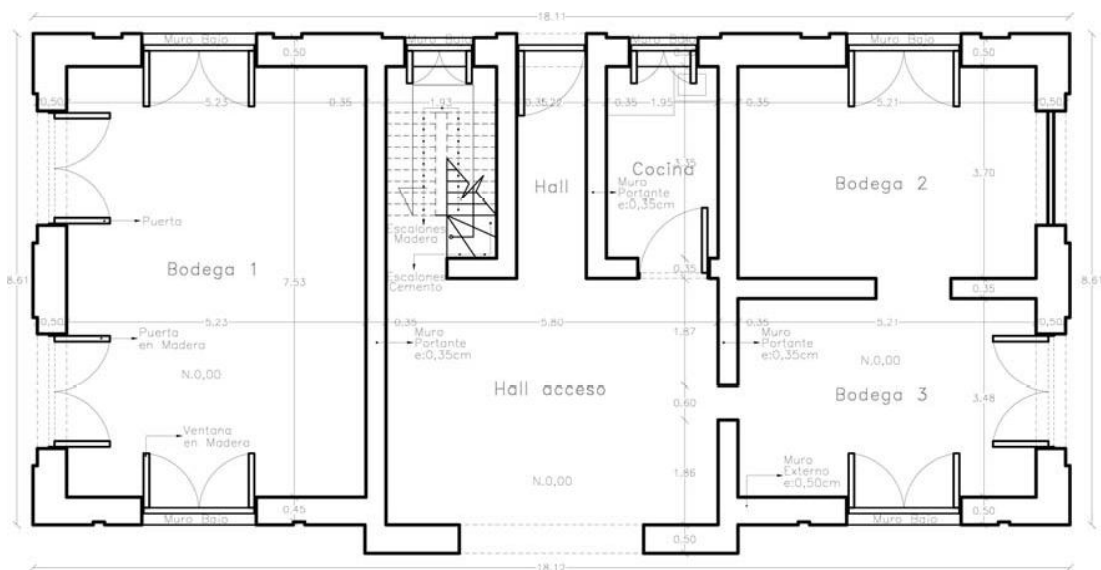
Estación de Picalaña en Ibagué. Planta del primer piso
